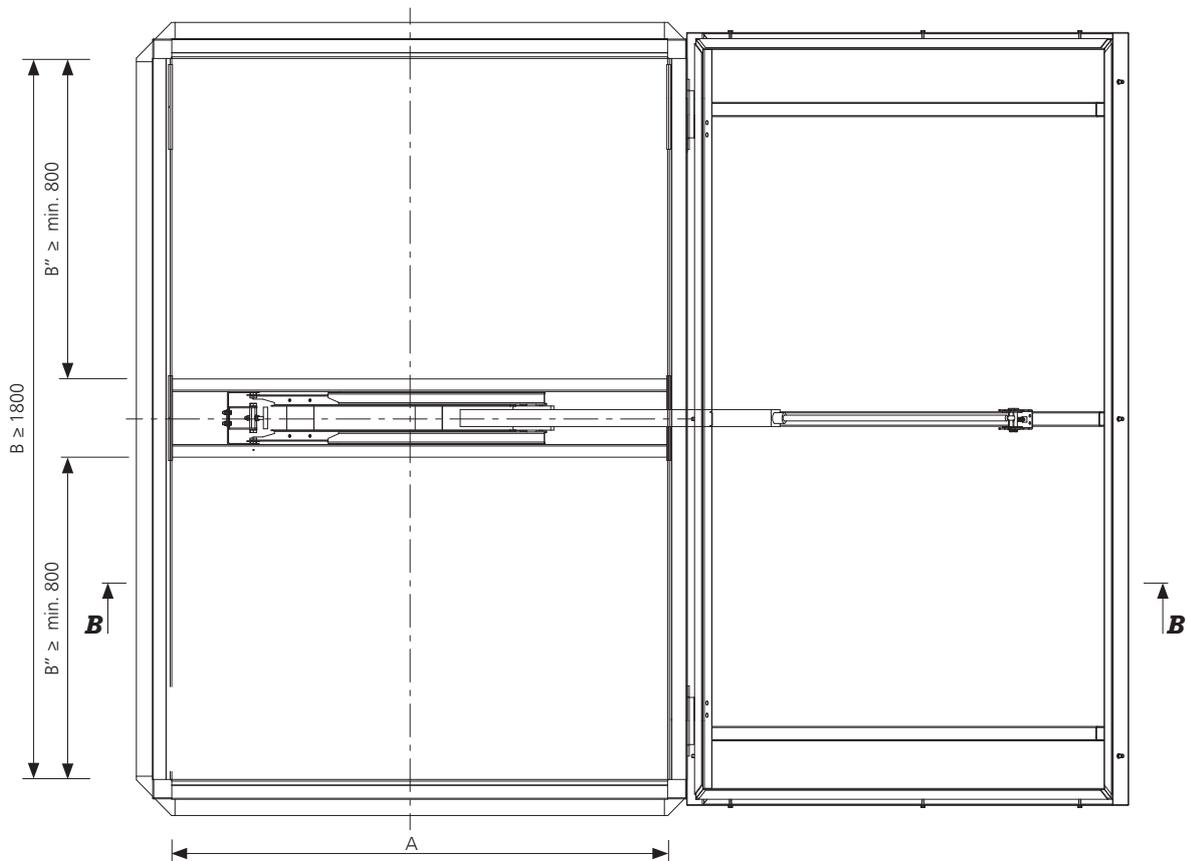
Vue de haut d'un lanterneau de désenfumage et d'accès toiture mcr PROLIGHT C/E en position ouverte, dimensions en mm
